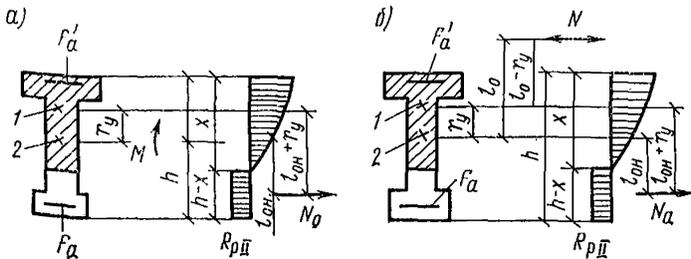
Схемы усилий и эпюра напряжений в поперечном сечении элемента при расчете его по образованию трещин, нормальных к продольной оси элемента, в зоне сечения, растянутой от действия внешних нагрузок
